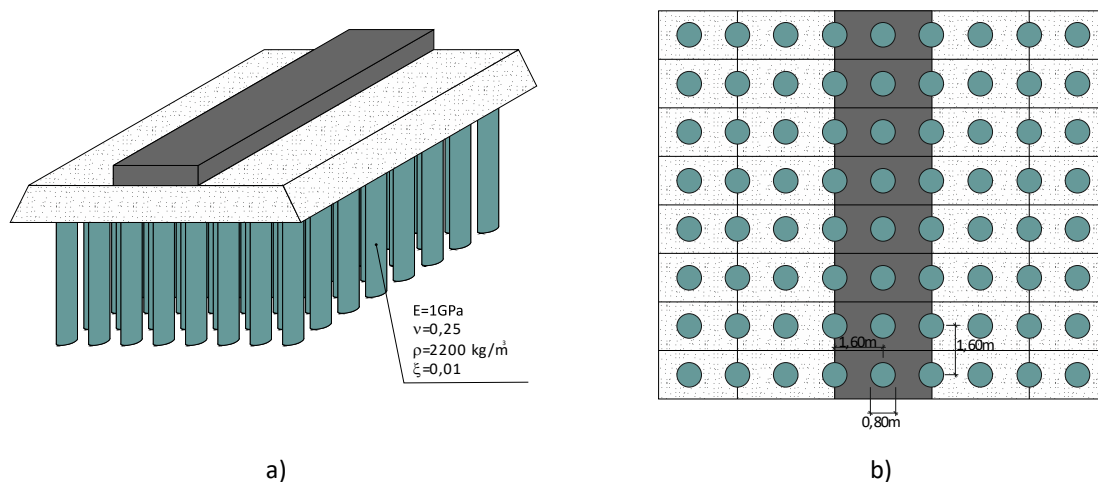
Ilustração esquemática da solução de reforço: a) vista geral; b) vista em planta.
